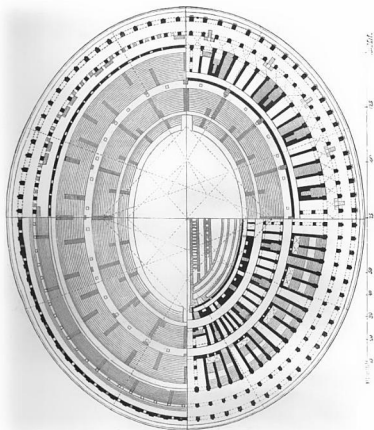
Grundriss des Flavianischen Amphitheaters.
